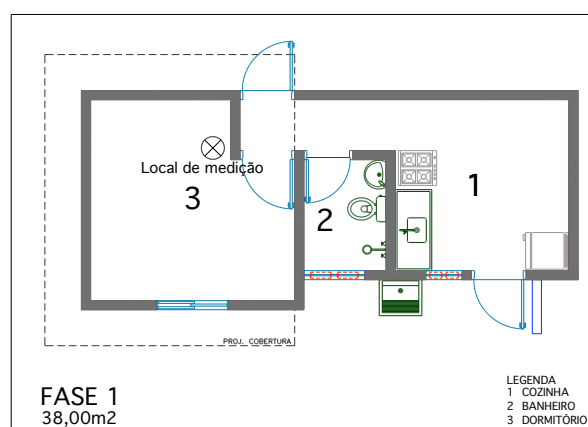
Planta arquitetônica do Protótipo de Estrutura Metálica com destaque para o local de medição. Fonte: LAB-ARQ /USF.
